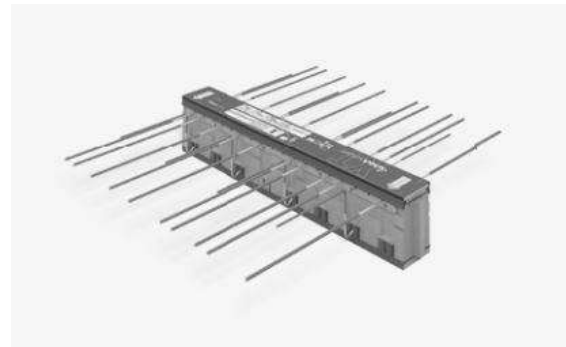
Schöck Isokorb® T typ SQP s přípojným adaptérem: Podeřný balkón
